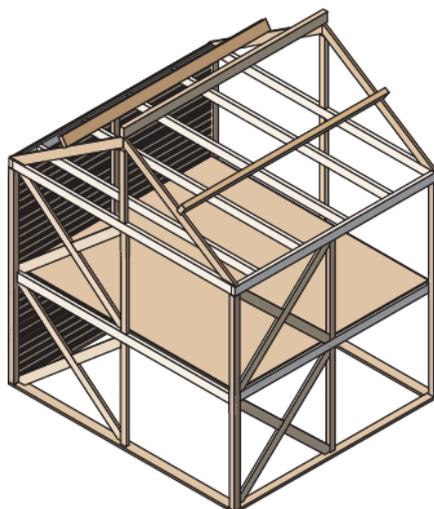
SCHÉMA D'UNE CONSTRUCTION EN « POTEAUX/POUTRES » [8]
